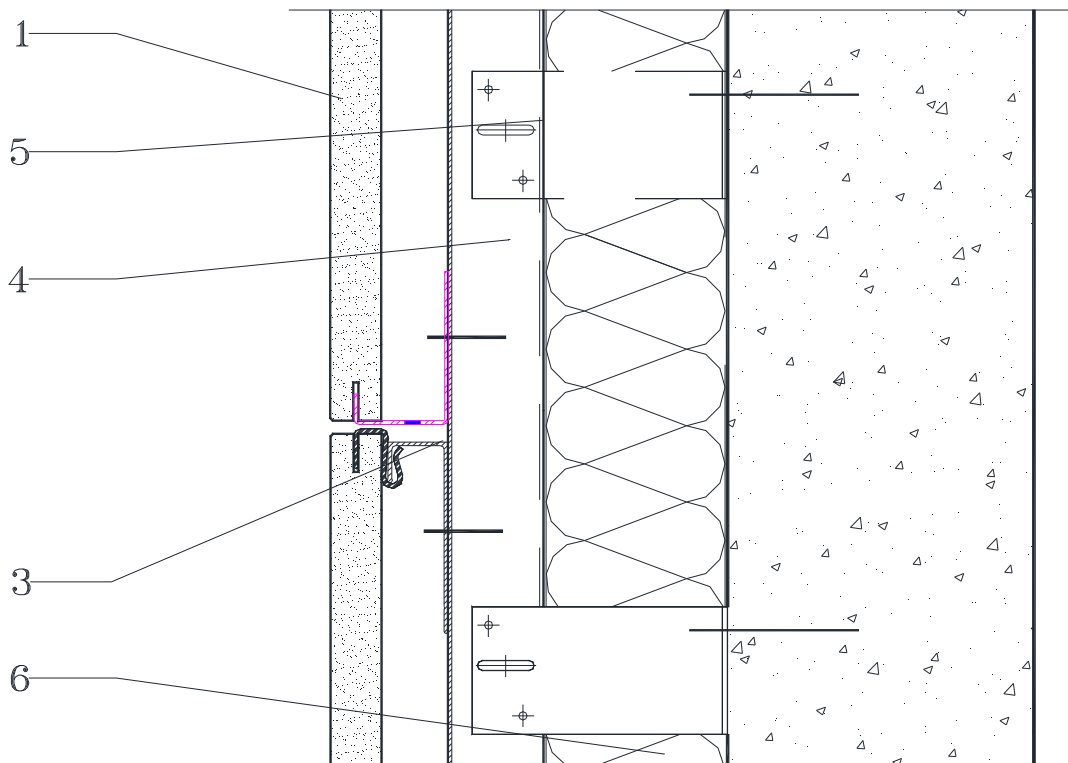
Joint horizontal (coupe verticale) pose directe sur support
